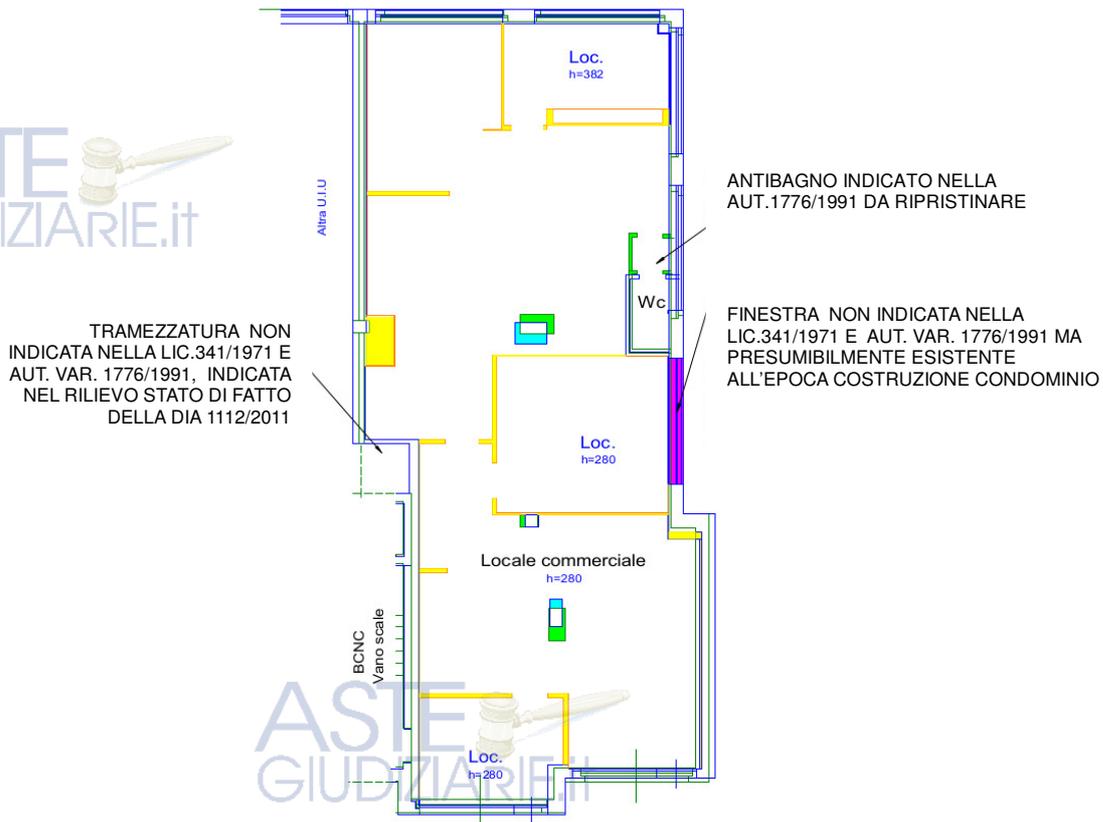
Confronto fra planimetrie rilievo/autorizzato
